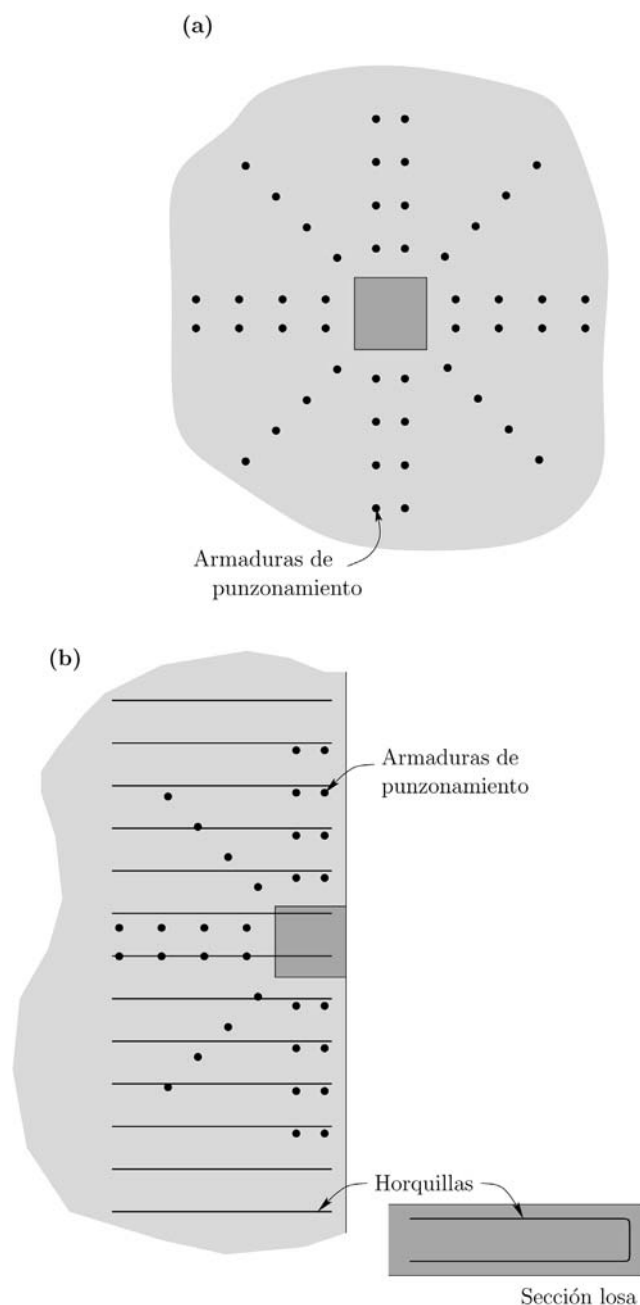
Armaduras transversales: (a) columna central (C3); columna de borde (C2).
